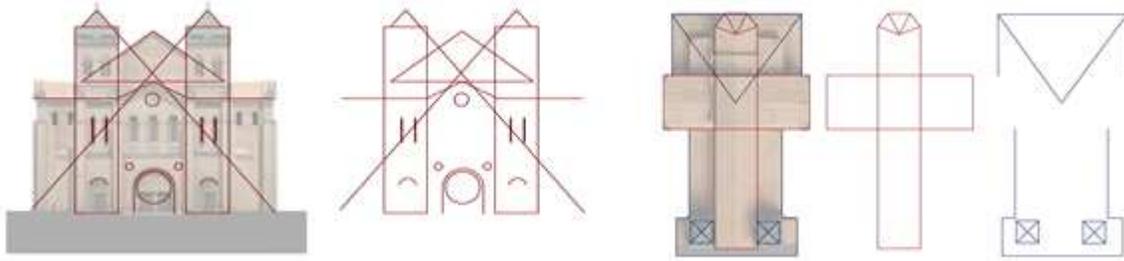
Geometría euclidiana encontrada en la fachada frontal y las cubiertas
